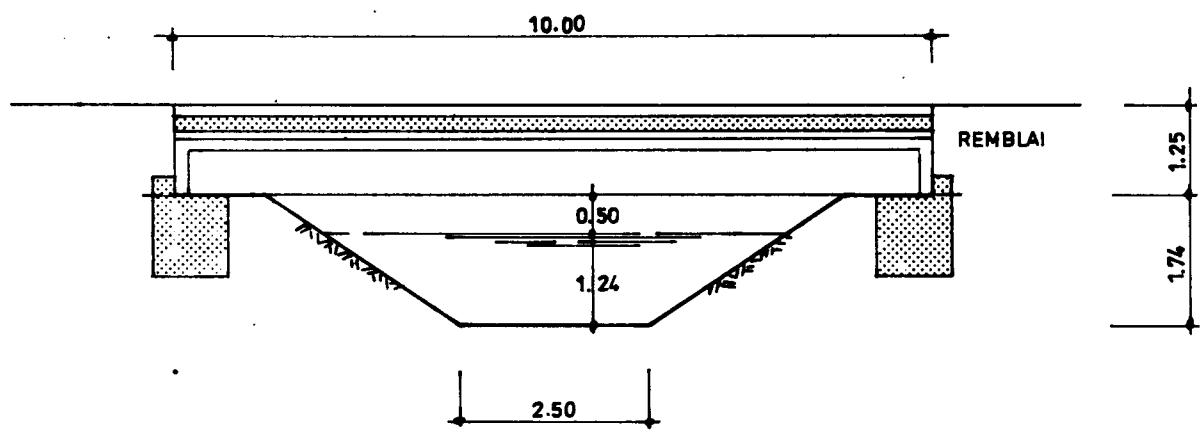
PONT SUR LE GORGOL NOIR PLAN TYPE
